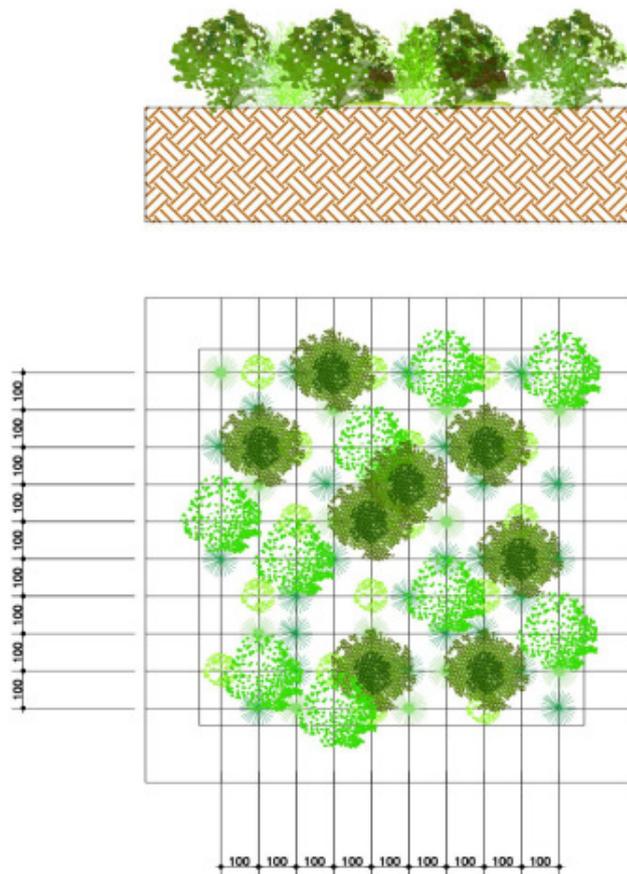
MODULO F – Rafforzamento delle aree umide
